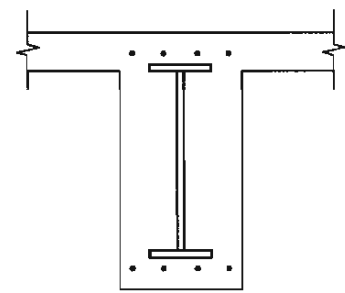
型钢混凝土梁的型钢截面配筋形式
